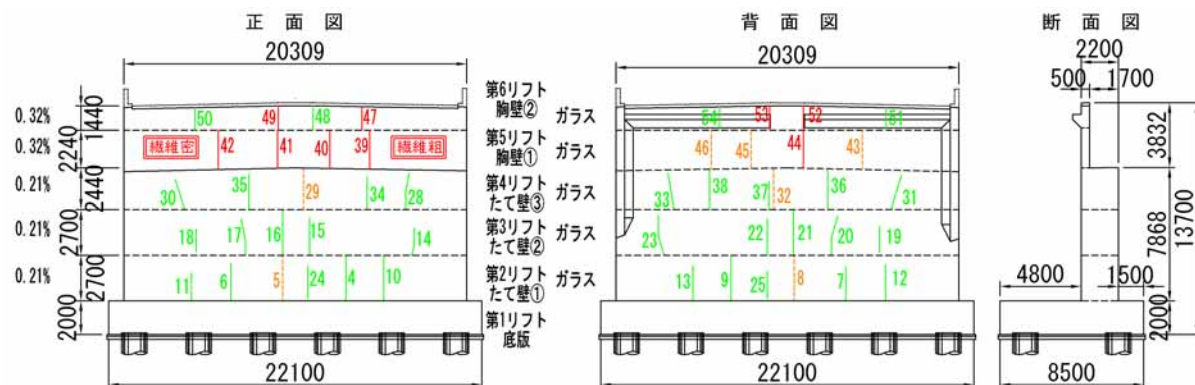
アラミド繊維ひび割れ発生状況
